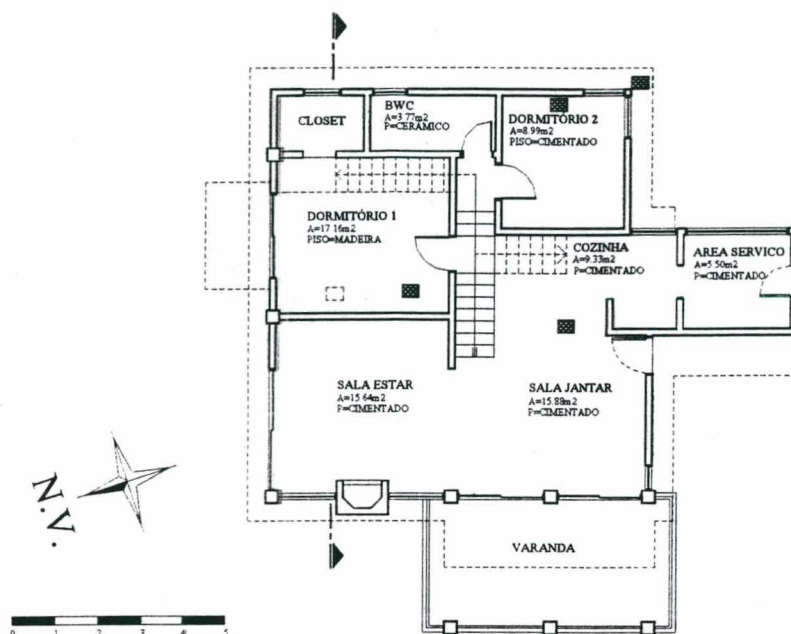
Planta Baixa Pavimento Térreo Residência 3.
